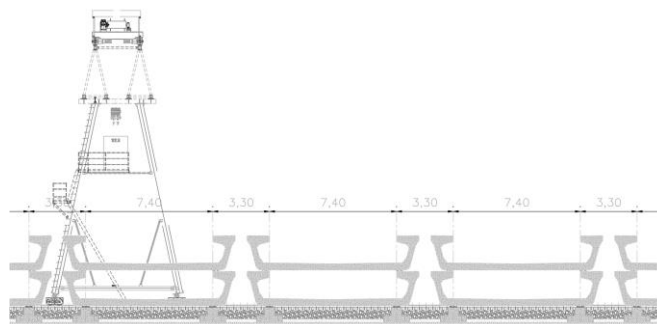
Dibujo almacén de vigas U-beam sobre pedestales
